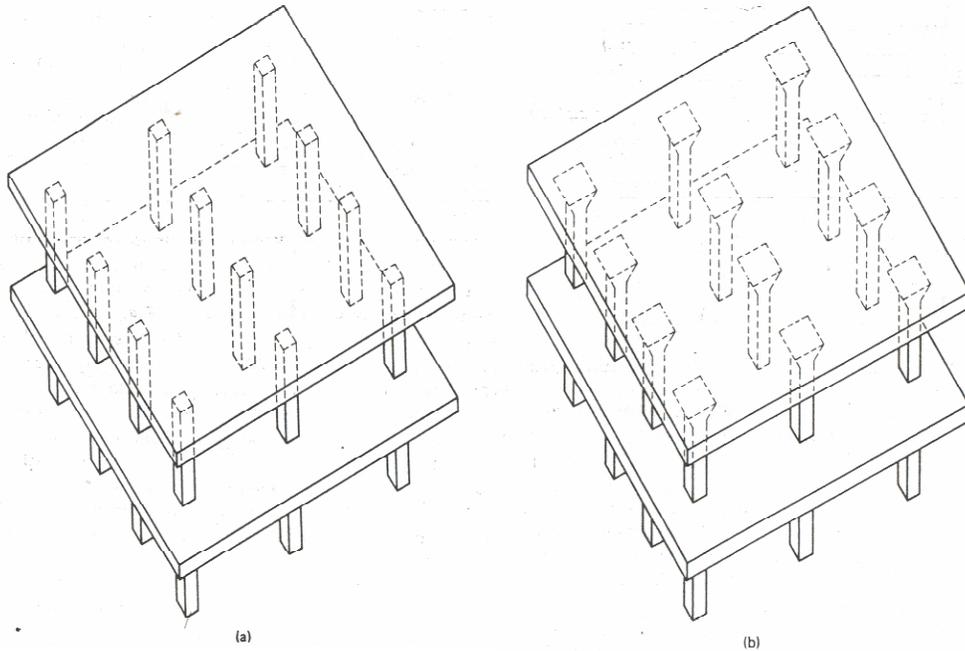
Tipos de losas macizas planas: a) Sin ábacos y capiteles, b) Con ábacos y capiteles.
